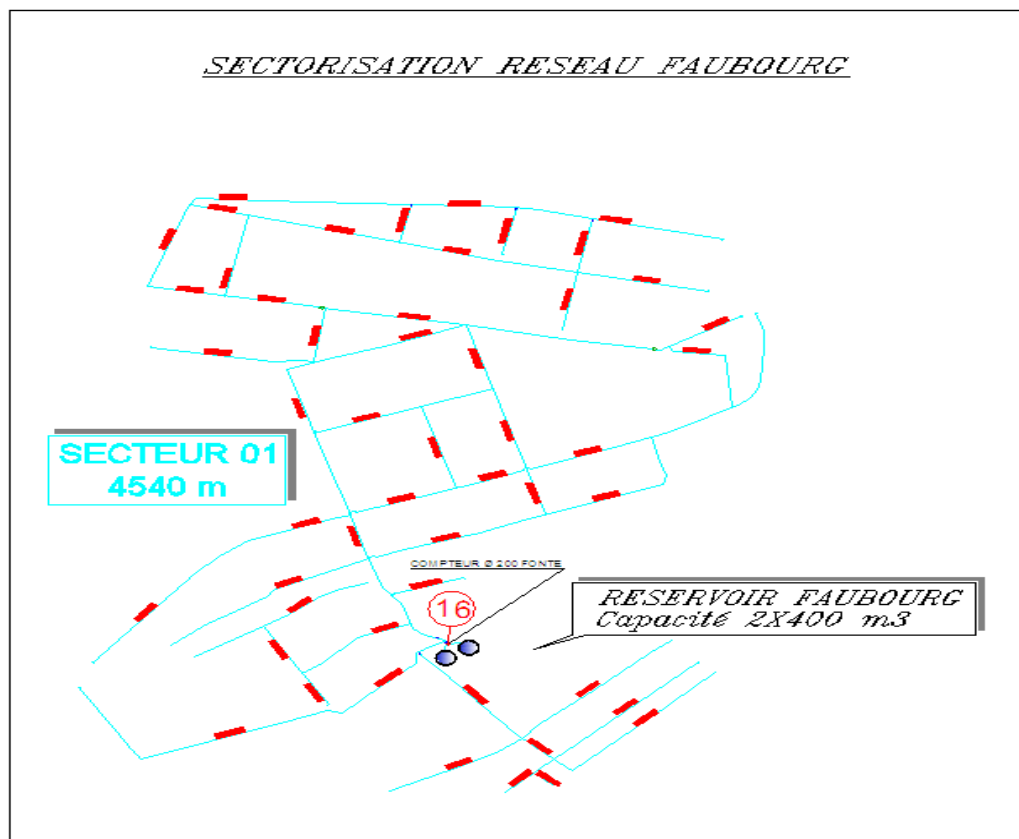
Plan de sectorisation du secteur Faubourg.
